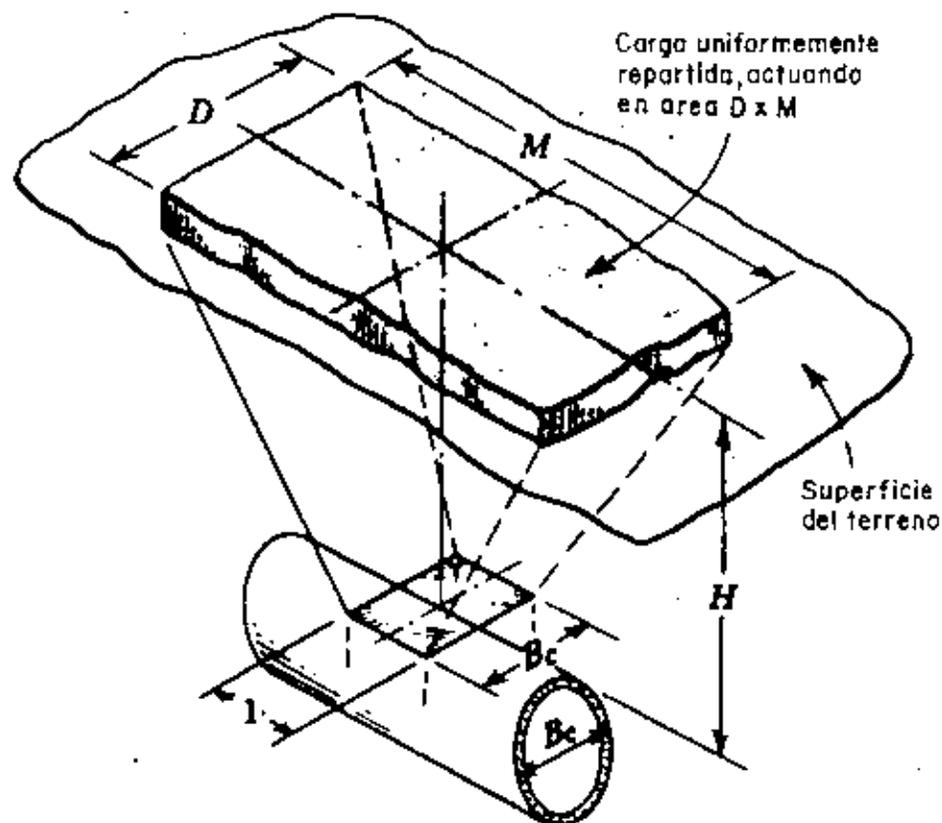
CARGA DISTRIBUIDA SOBREPUESTA CENTRADA VERTICALMENTE SOBRE EL CONDUCTO.
